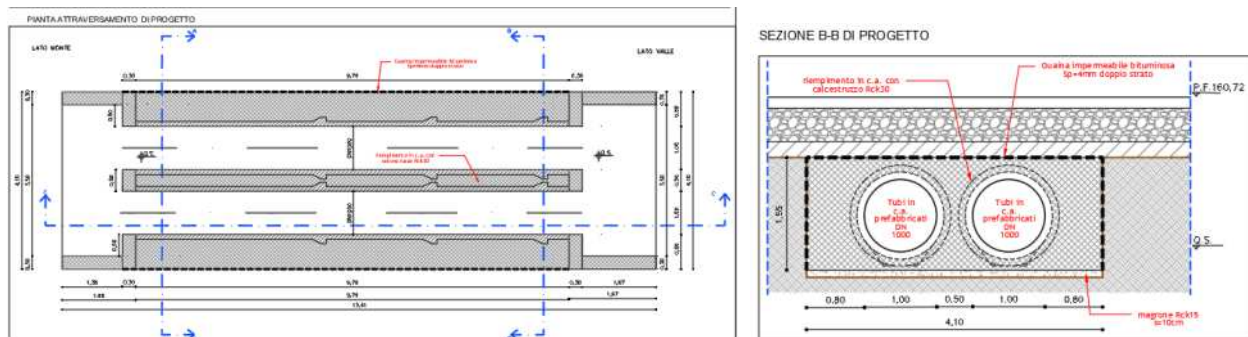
Pianta e Sezione Tombino Km 18+978,74
